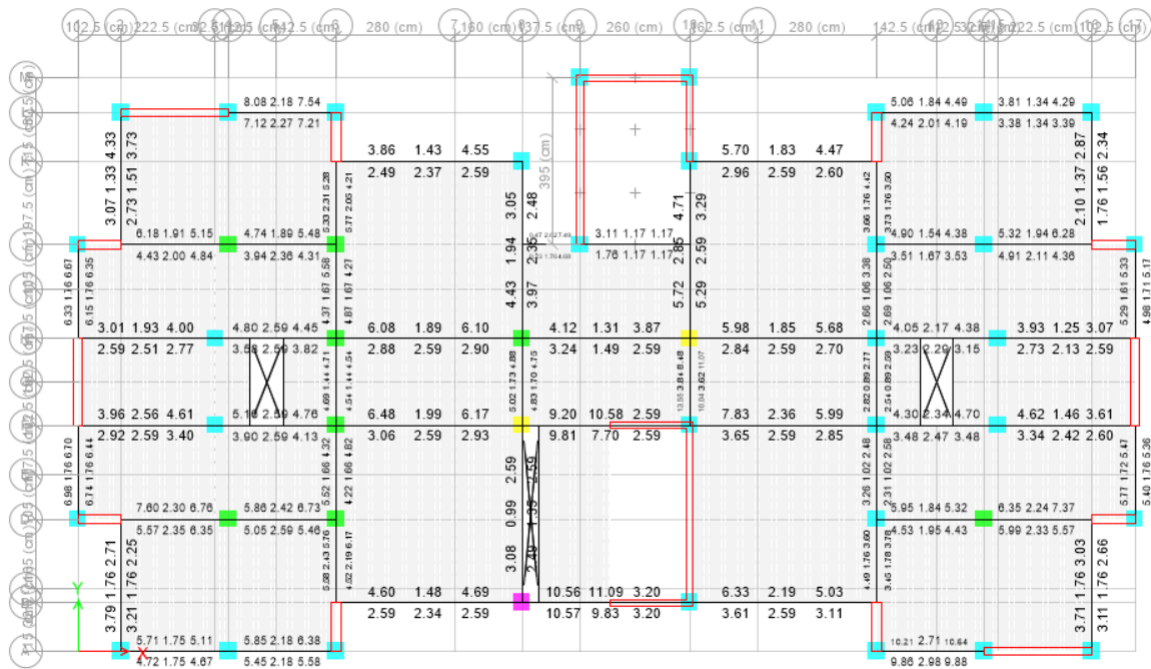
Diseño de acero longitudinal en vigas Piso más cargado (Piso 4) Sistema Dual - Edificio Blesser. Fuente: Elaboración Propia.
